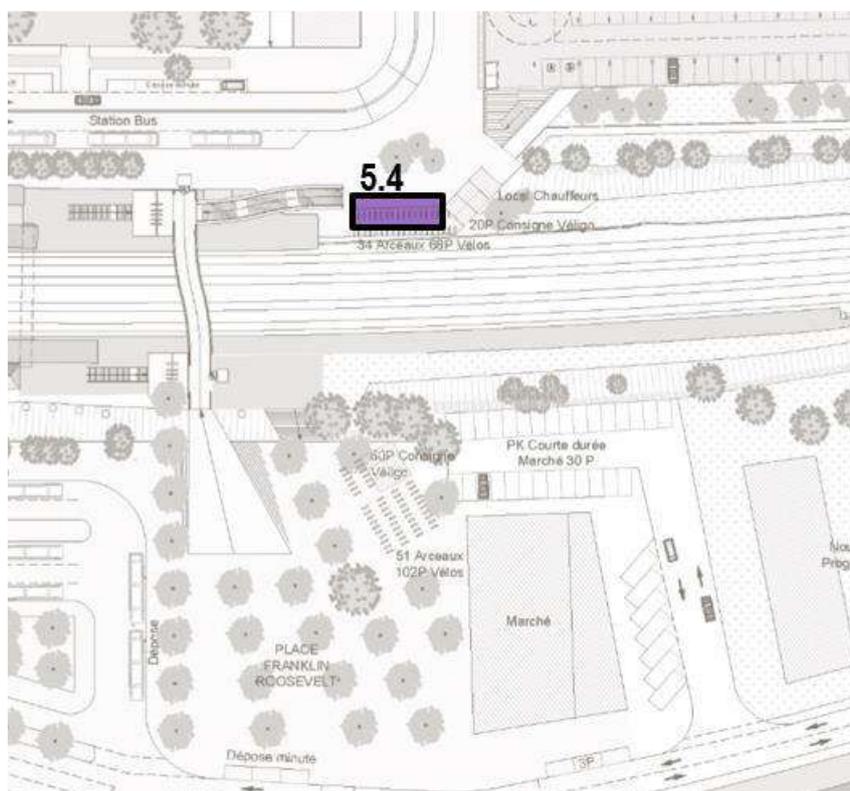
Arceaux Place de la Gare Nord-Ouest
